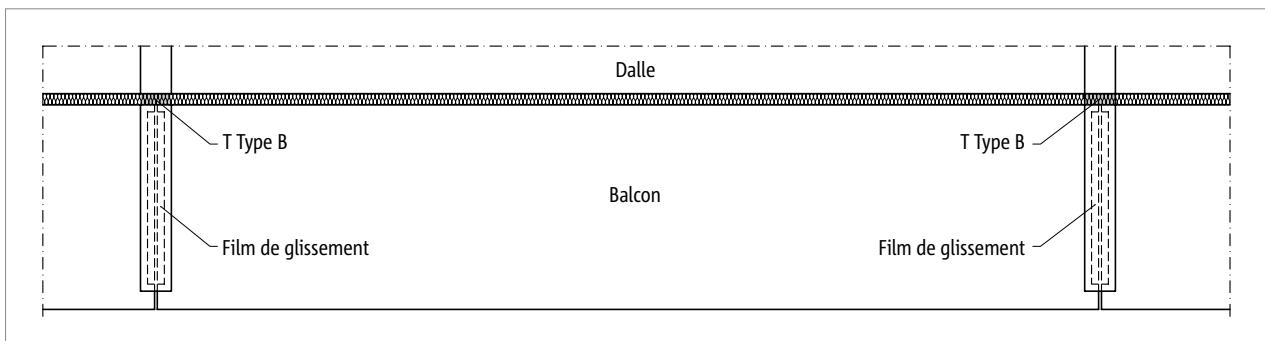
Schöck Isokorb® T Type B : Construction de balcon avec poutrelles en porte-à-faux (balcon préfabriqué)
